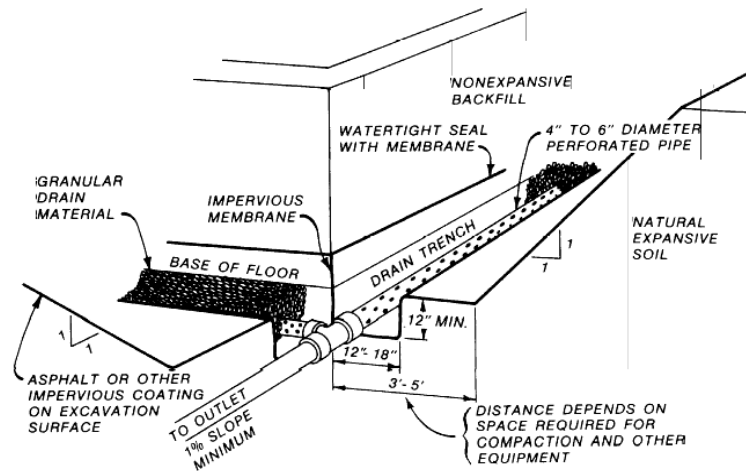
Sistema de drenagem a volta da estrutura (Department of the Army USA, 1983).
